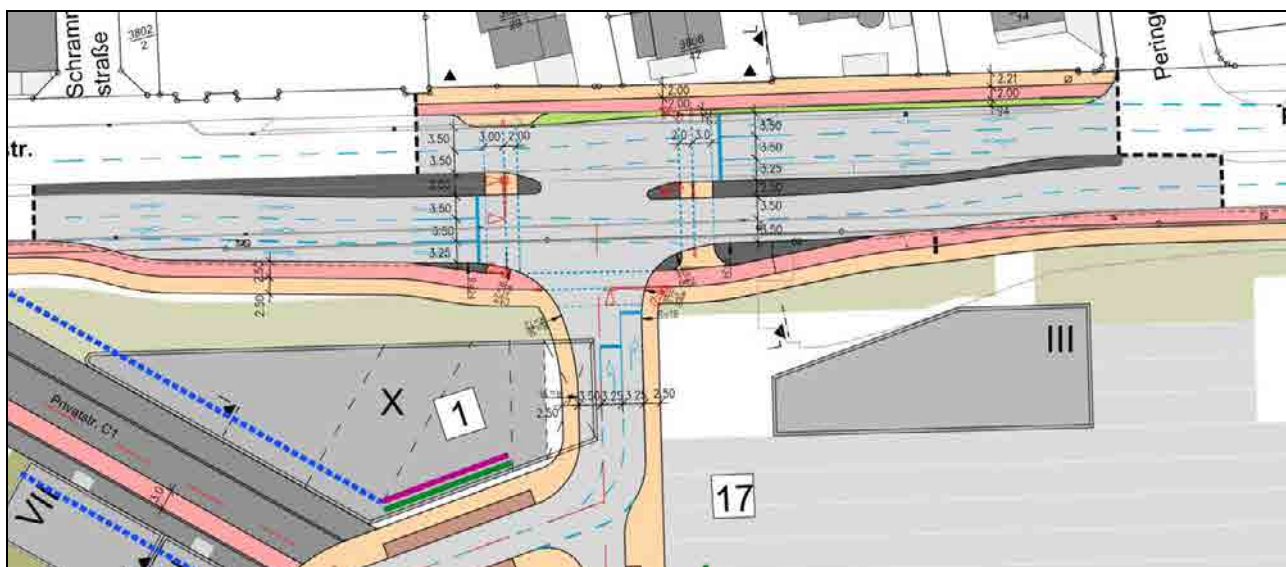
Planskizze (Auszug) zum Knotenpunkt Römerstraße/Planstraße A2 (Quelle: Goldbrunner Ingenieure GmbH, Stand 08.03.2022)
